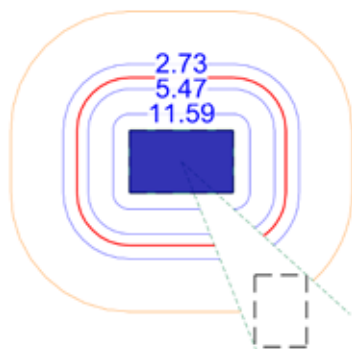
Erforderliche Durchstanzbewehrung je Rundschnitt an Rechteckstütze
